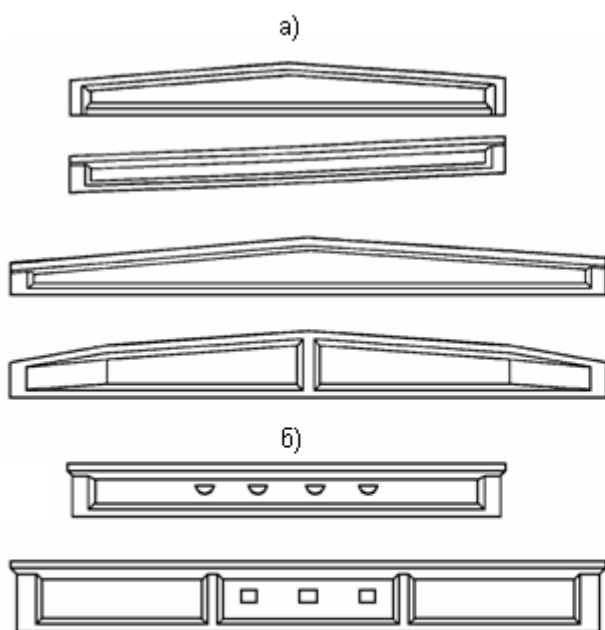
Железобетонные балки покрытий: а - для скатных покрытий, б - для плоских покрытий
